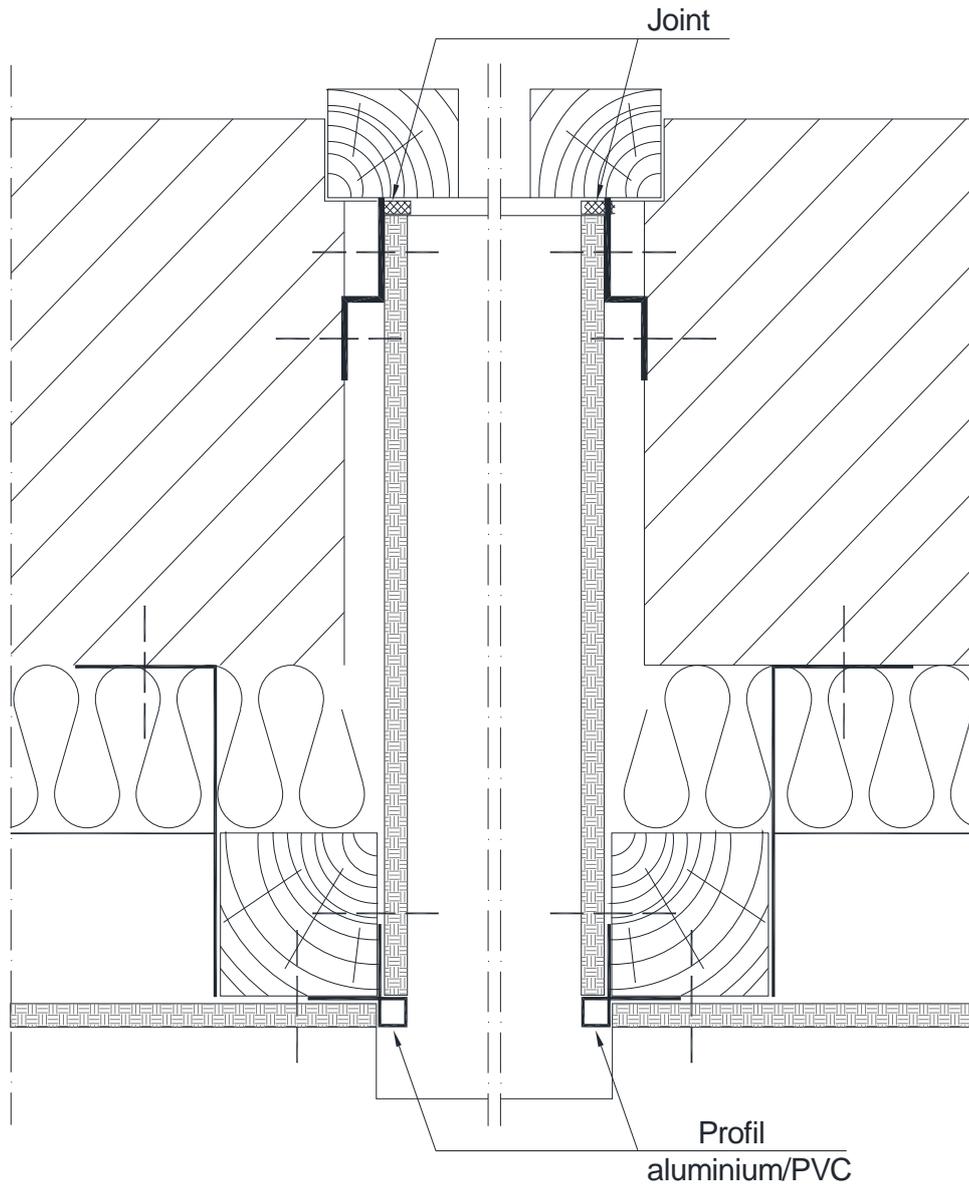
Encadrement de baie avec isolation complémentaire (Coupe horizontale)
